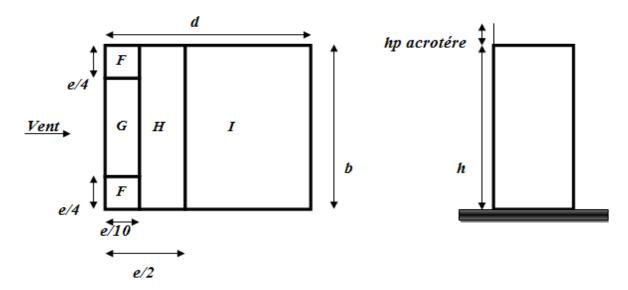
Repartition des Zone de pression extérieur sur la toiture.
